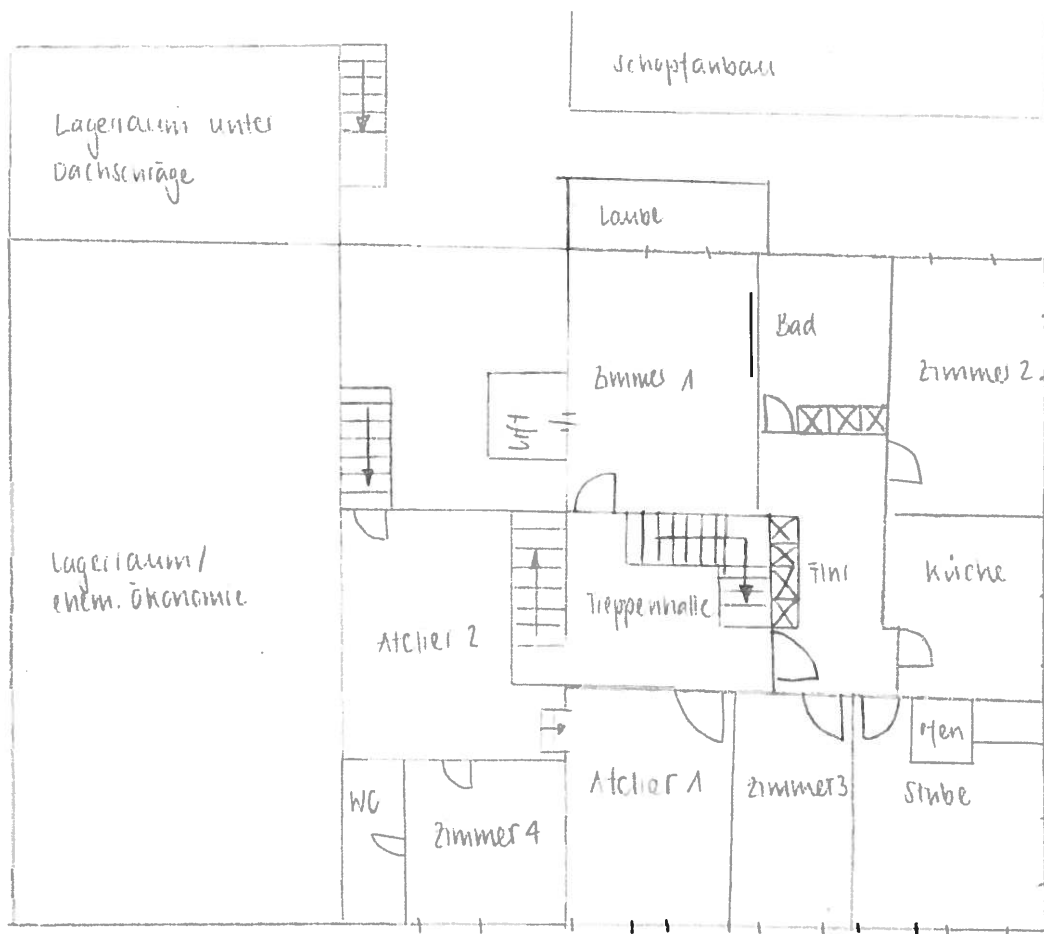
Grundriss Obergeschoss, Skizze IBID 2015. Auf dem Plan fehlen die Einbauten in der Werkstatt/ehemaligen Ökonomie.
